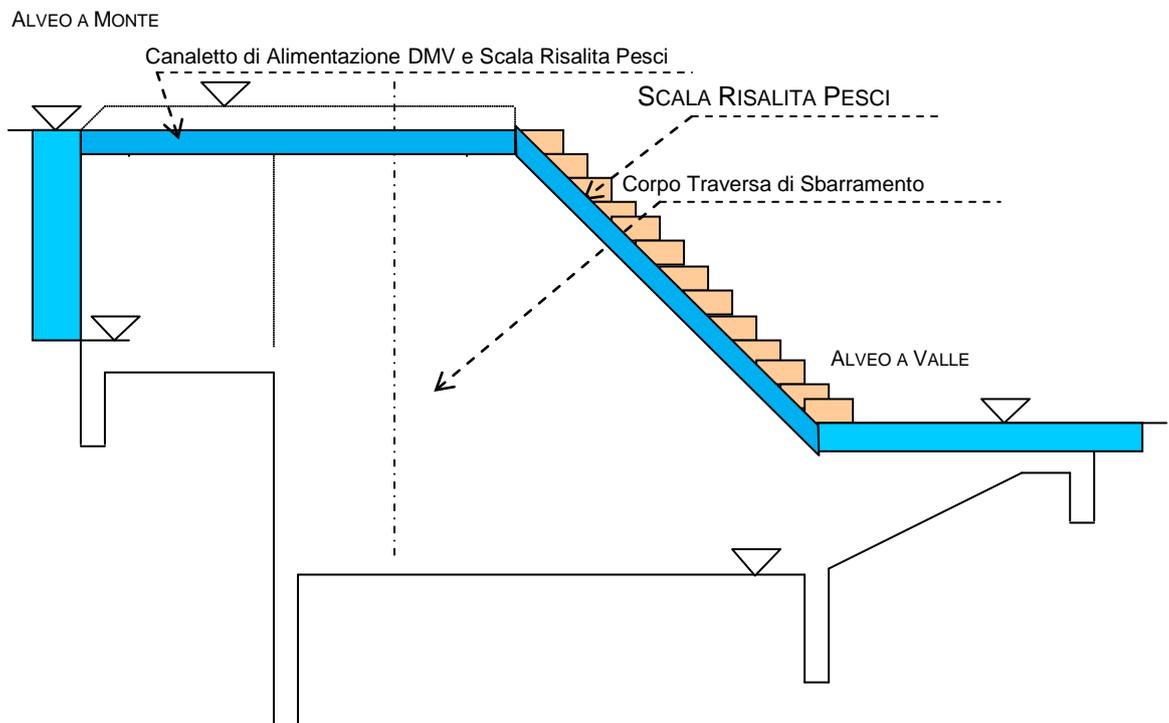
SEZIONE TRASVERSALE DELLO SBARRAMENTO
